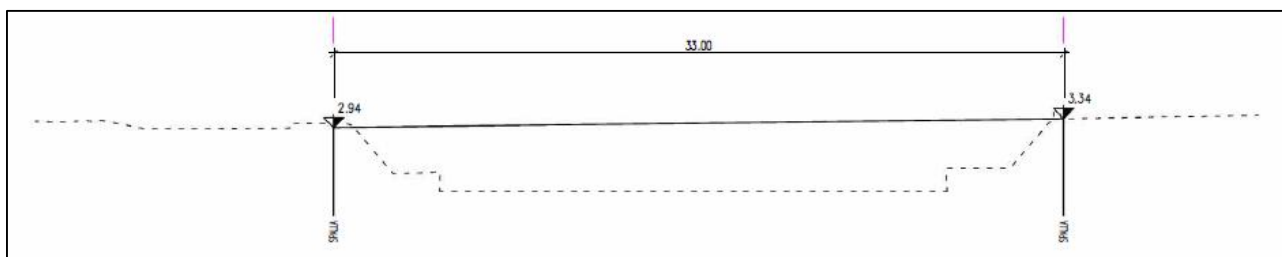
Profilo longitudinale con ampiezza sezione idraulica e quota sponde
